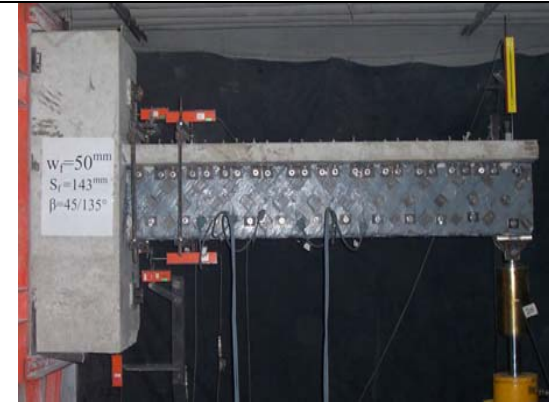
Kiriş-2 Yetersiz Kesme Donatılı Kiriş
